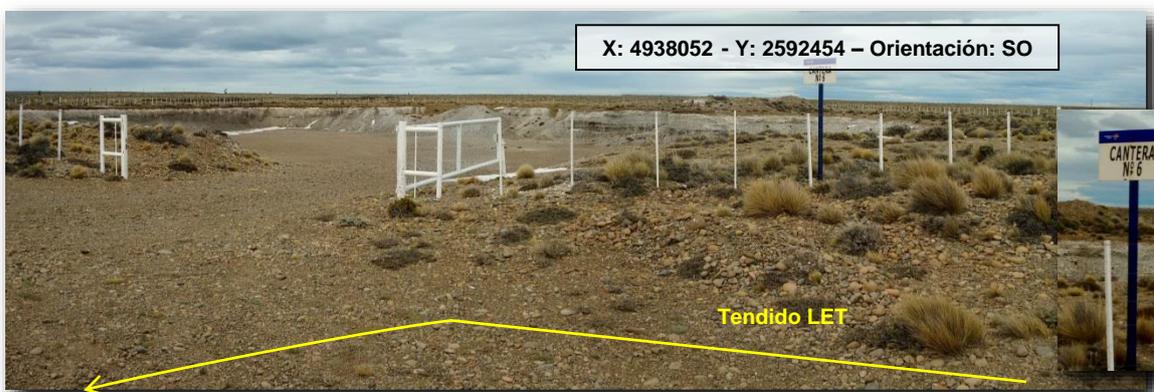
Cantera N° 6 hubicada al Oeste.
